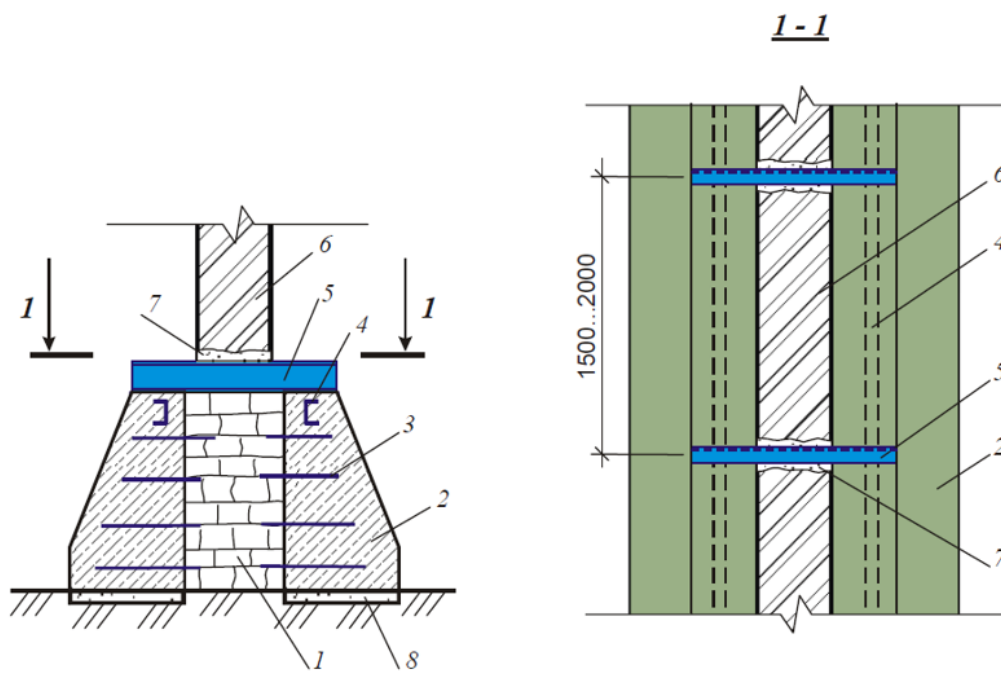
Усиление фундаментов монолитными бетонными банкетам:
